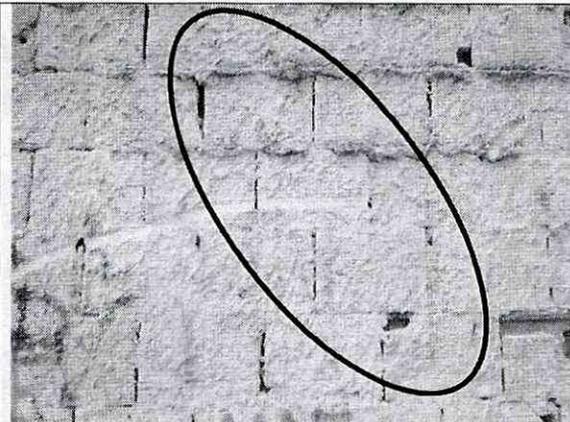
Fisuras en la parte inferior del tramo oriental.
